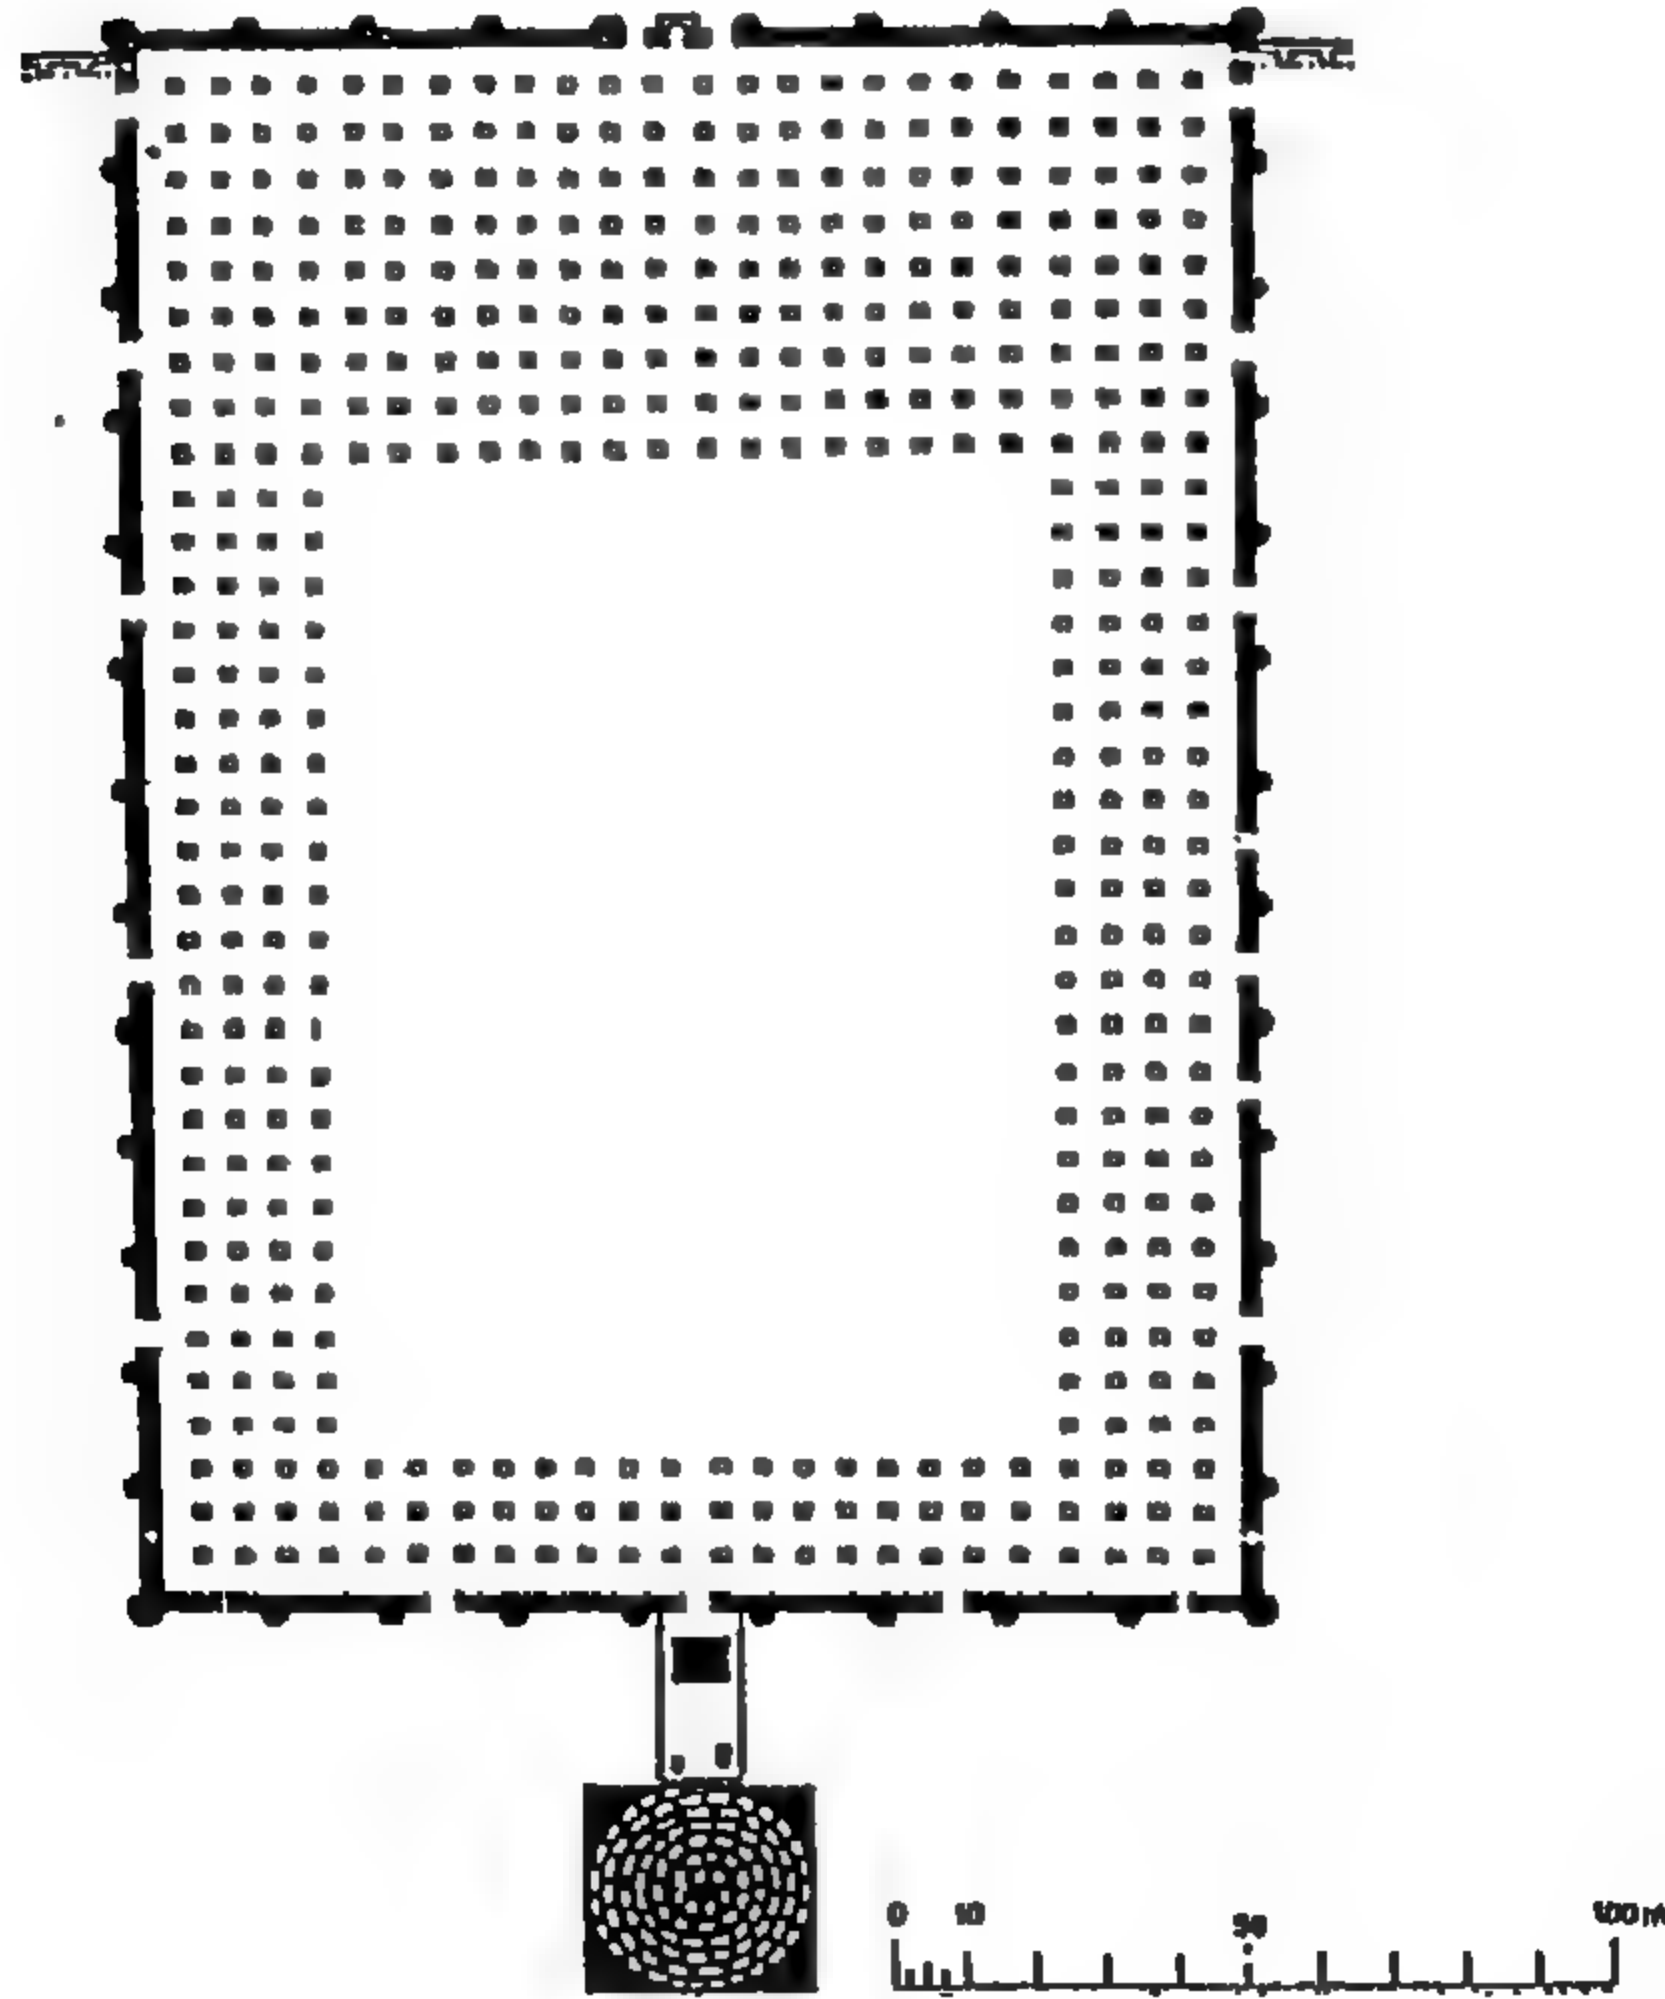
مسقط أفقي للجامع الأقصى في عهد الخليفة
